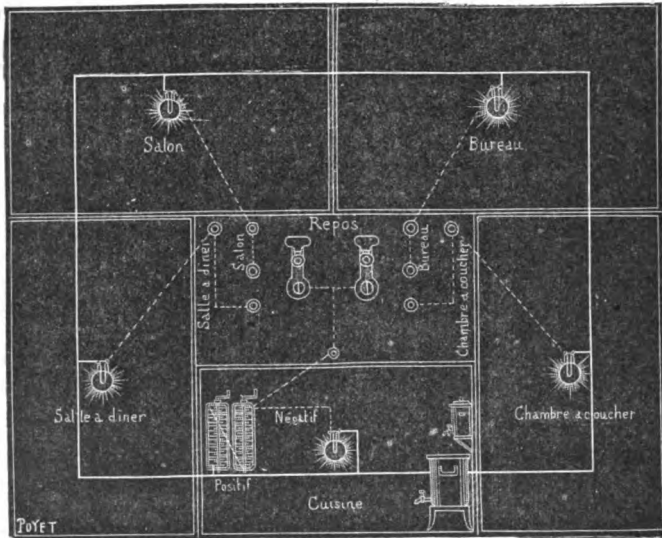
Plan, dressé par M. Gustave Trouvé, d'une installation de lumière électrique par piles, dans une maison.
